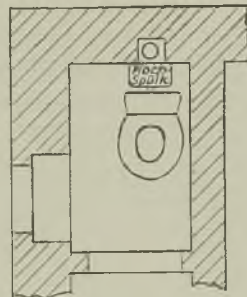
Grundriß zu einem Abortraum. Der Klosettkörper ist aus der Mitte parallel zur Wand verschoben. Das Fenster ist seitwärts angebracht.
